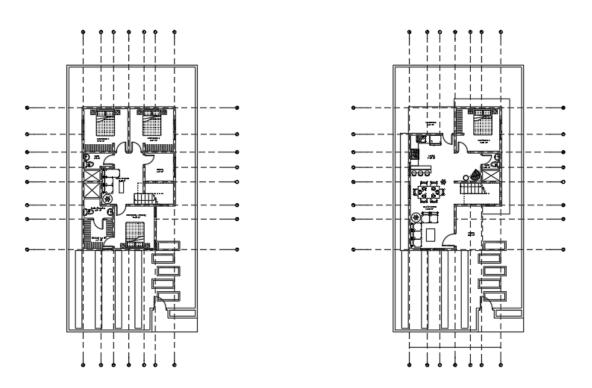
Planta arquitectónica, Vivienda Jacaranda
